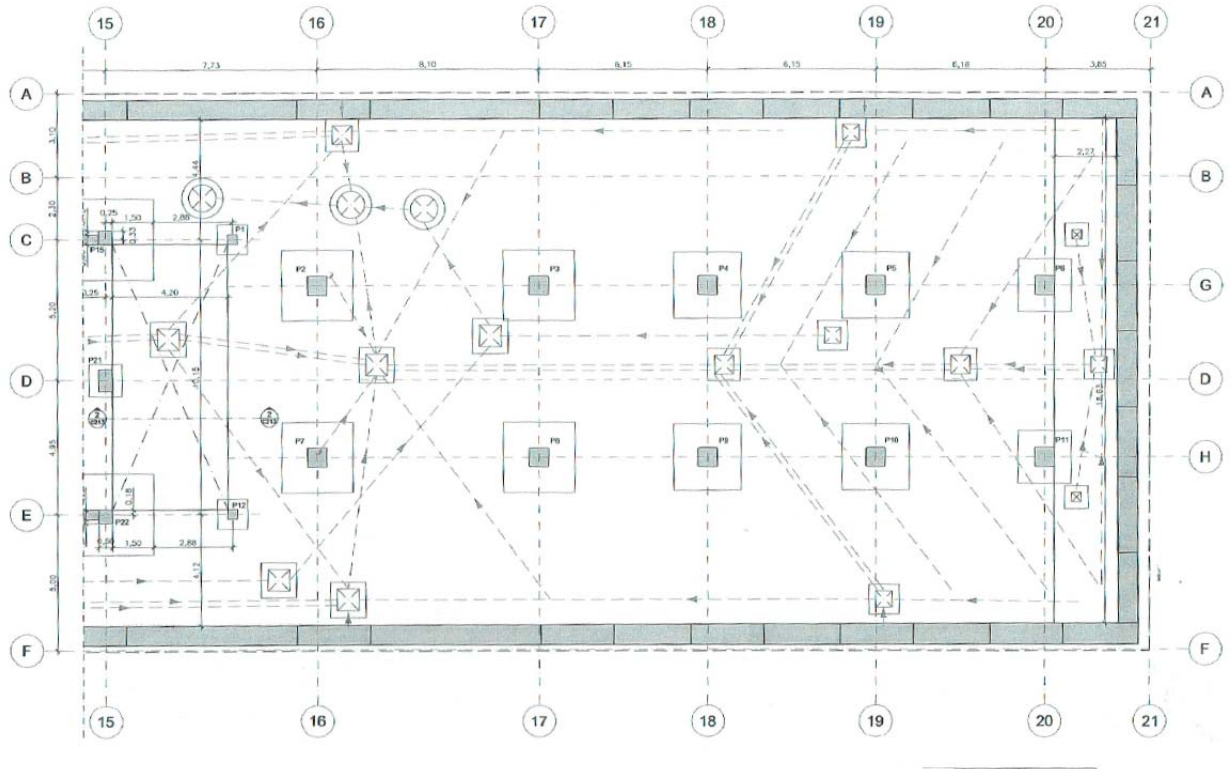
Planta de cimentación bajo la proyección de la posible ubicación de pabellón (Zona B)
